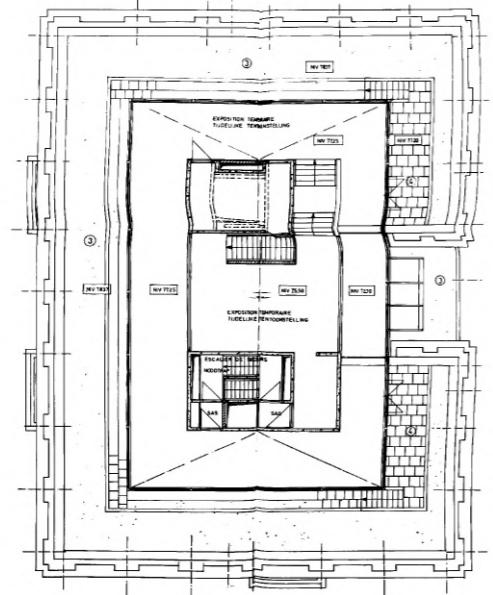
Plan de l'extension en hauteur de l'Altenloh, avant-projet de la phase II.
